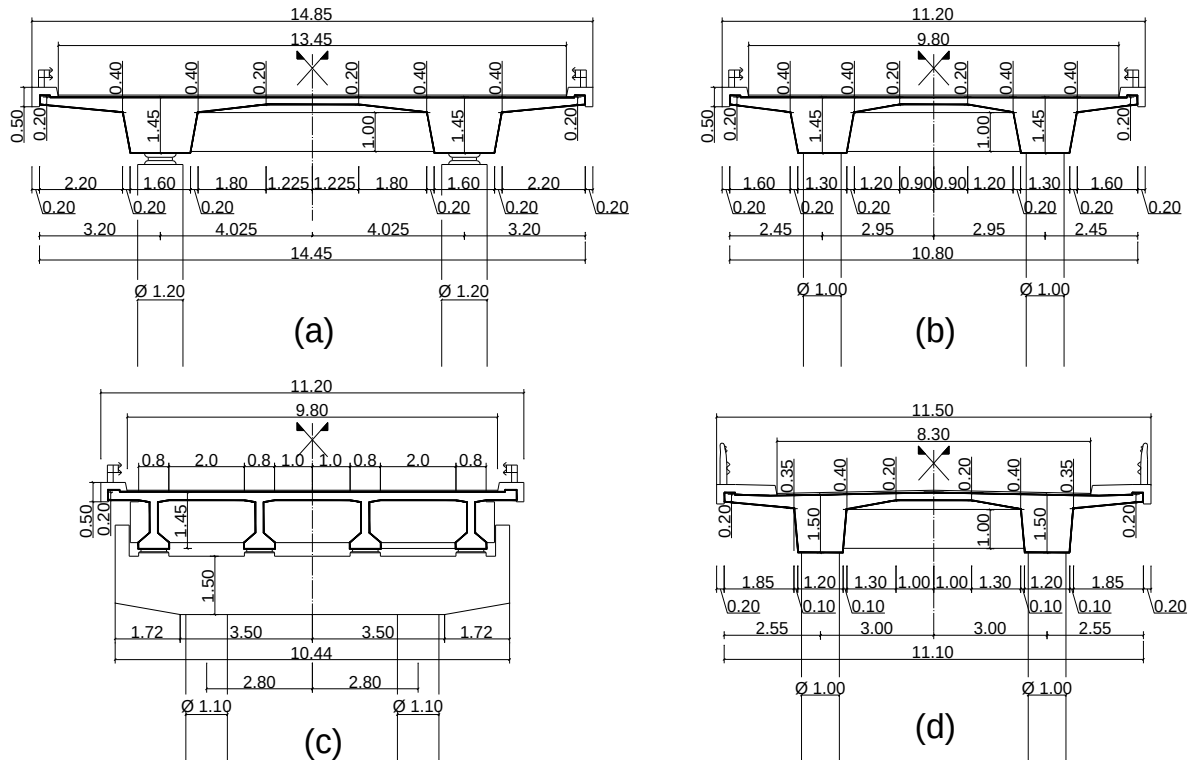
Sección transversal de los puentes. (a): P1. (b): P2 y P3. (c): P4. (d): P5.
